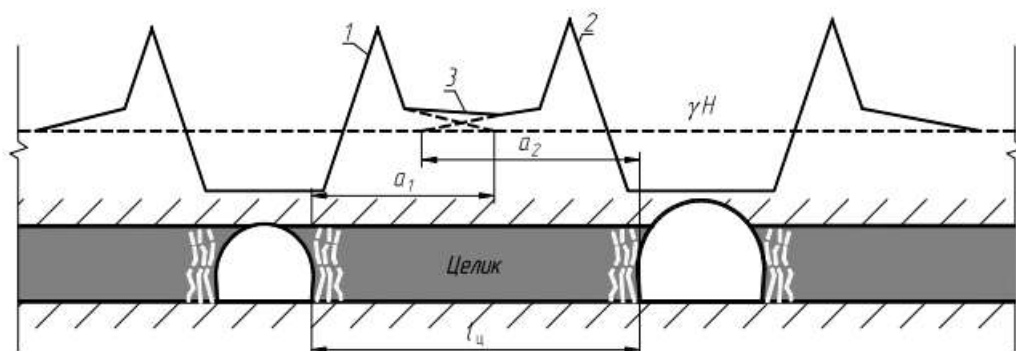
Схема формирования напряжений в породах кровли взаимовлияющих выработок: 1, 2 – эпюры напряжений в зоне опорного давления; 3 – участок взаимного наложения напряжений (суммарная эпюра)
